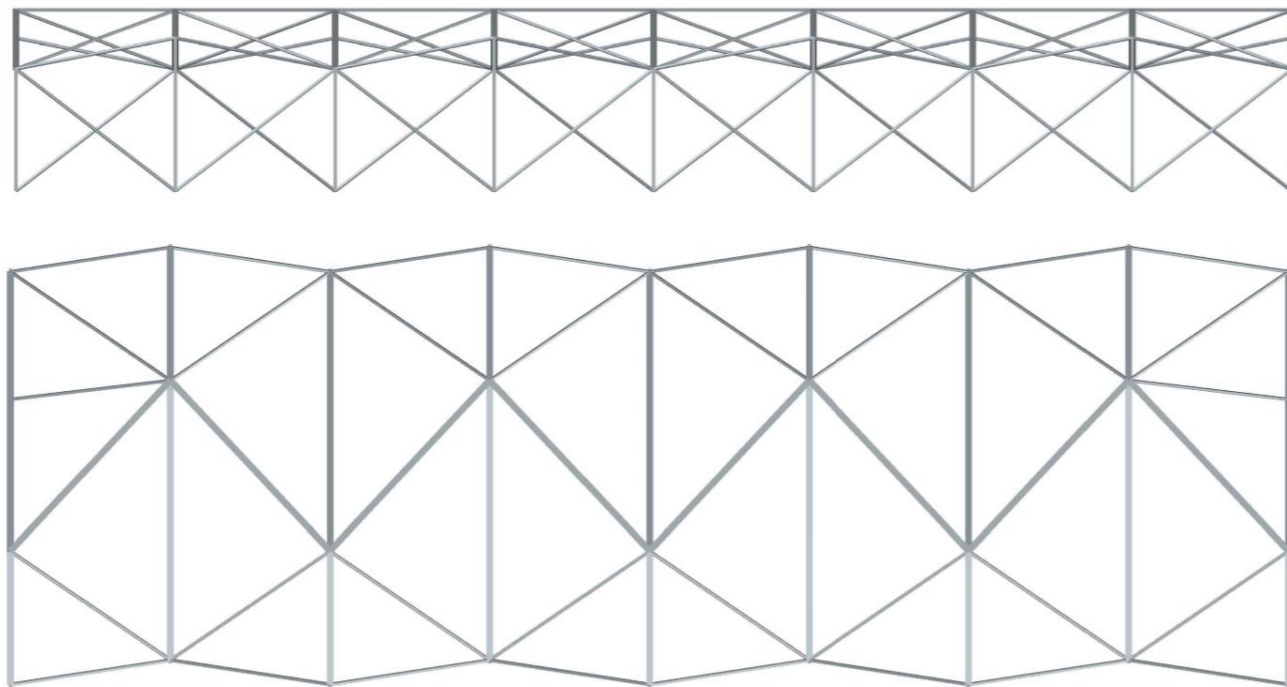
Alzado y planta de la estructura. (Fuente: Elaboración propia)
